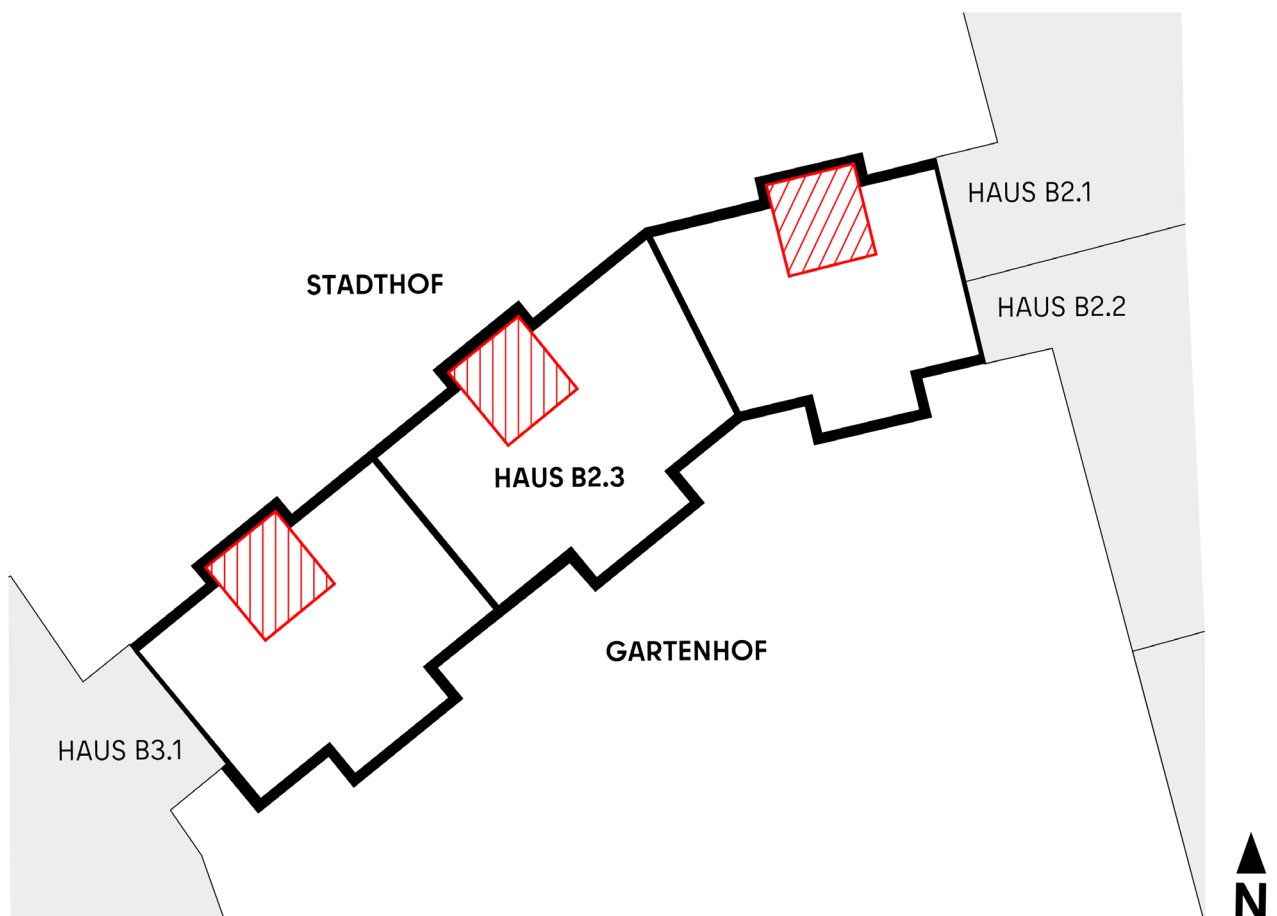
Schematischer Grundriss Regelgeschoss
